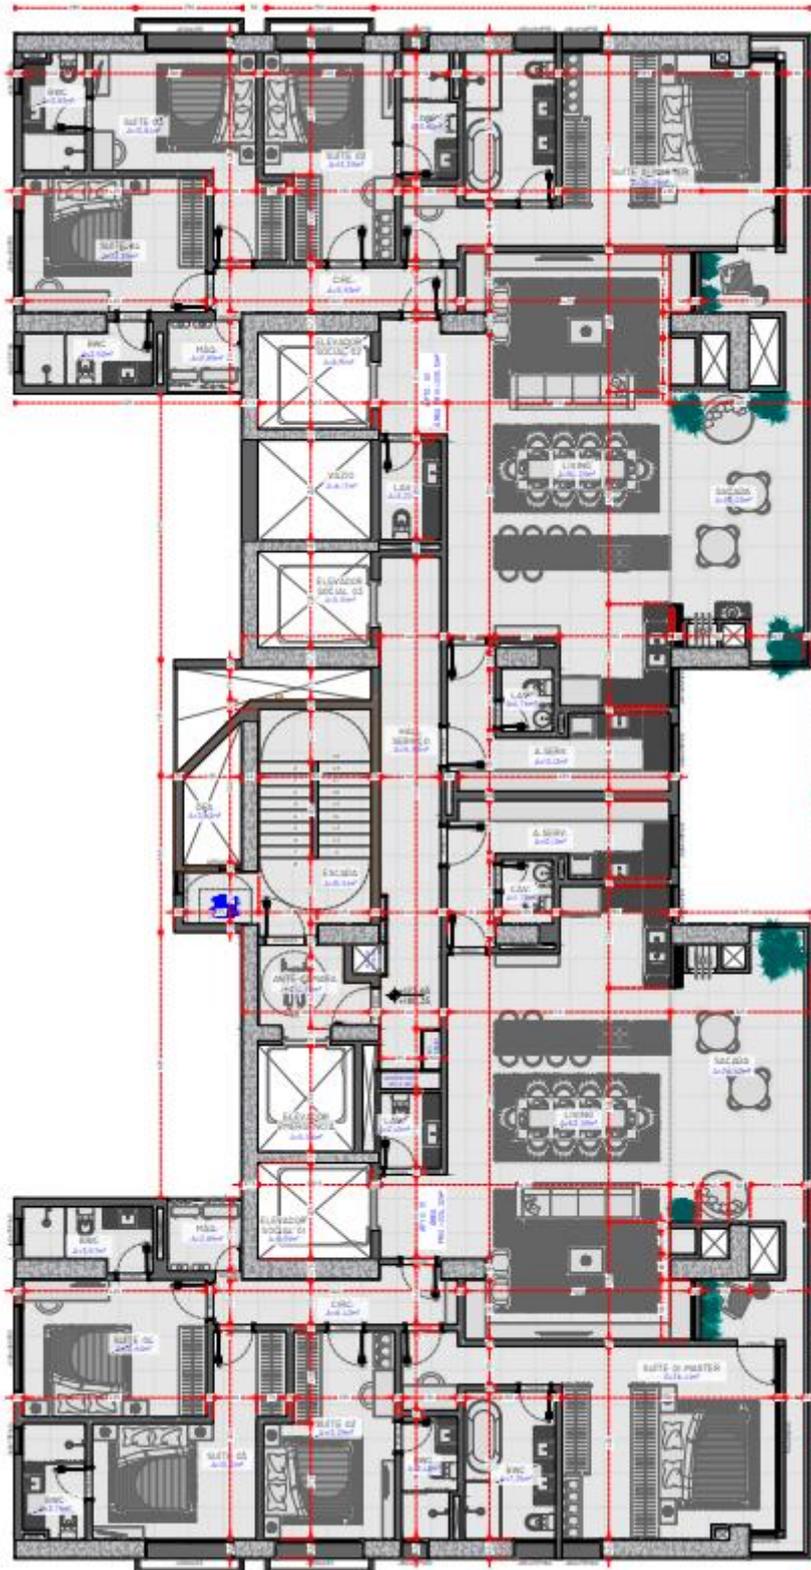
Pavimento Tipo B - (40º - 58º pavimento)
